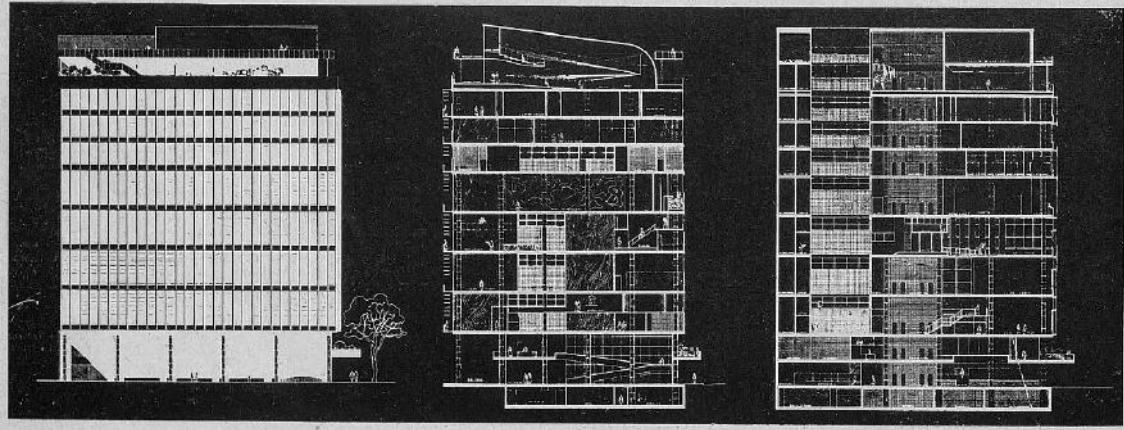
Fachada e cortes verticais da edificação. Fonte: Concours, 1948.
